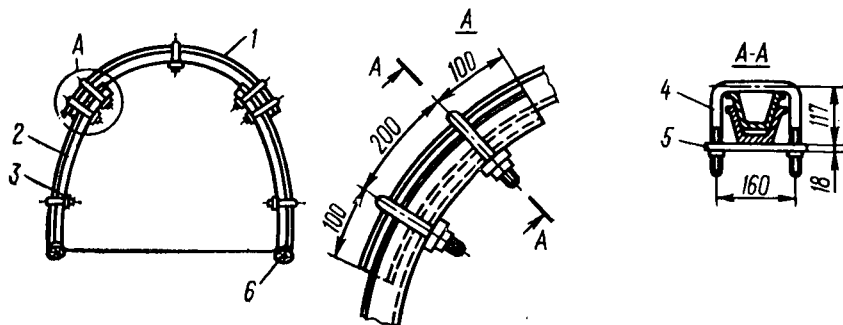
Металлическая арочная крепь из спецпрофиля: 1 — верхняк; 2 — стойки; 3 — стяжка; 4 — хомут; 5 — планка; 6 — лежень
